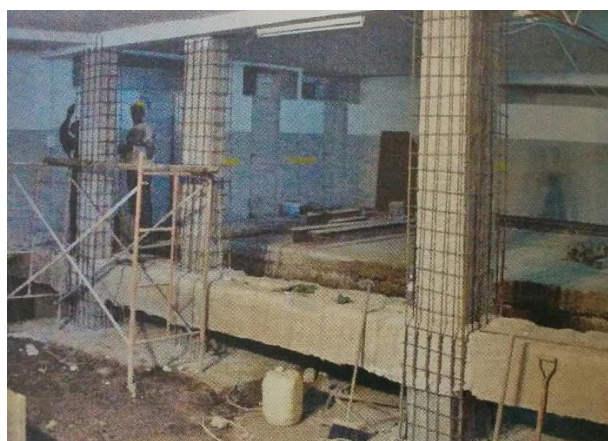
Exemplo de encamisamento com betão armado num pilar rectangular, adaptado de (Paisana dos Santos Lopes et al., 2008)
